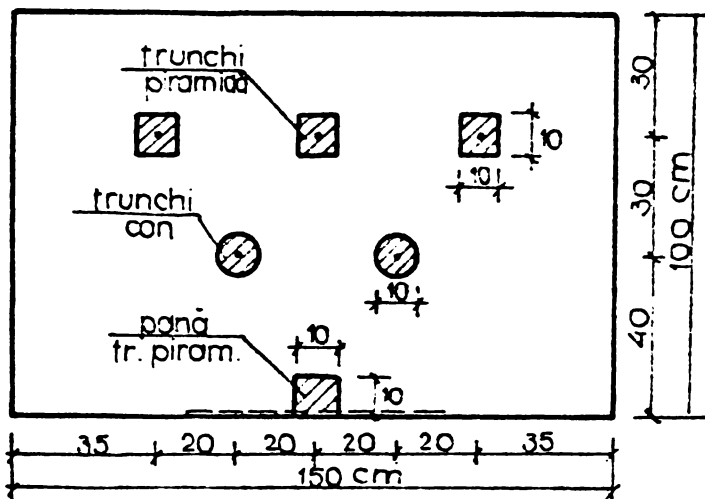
Planul de dispunere a ploturilor din beton (mulaje).
